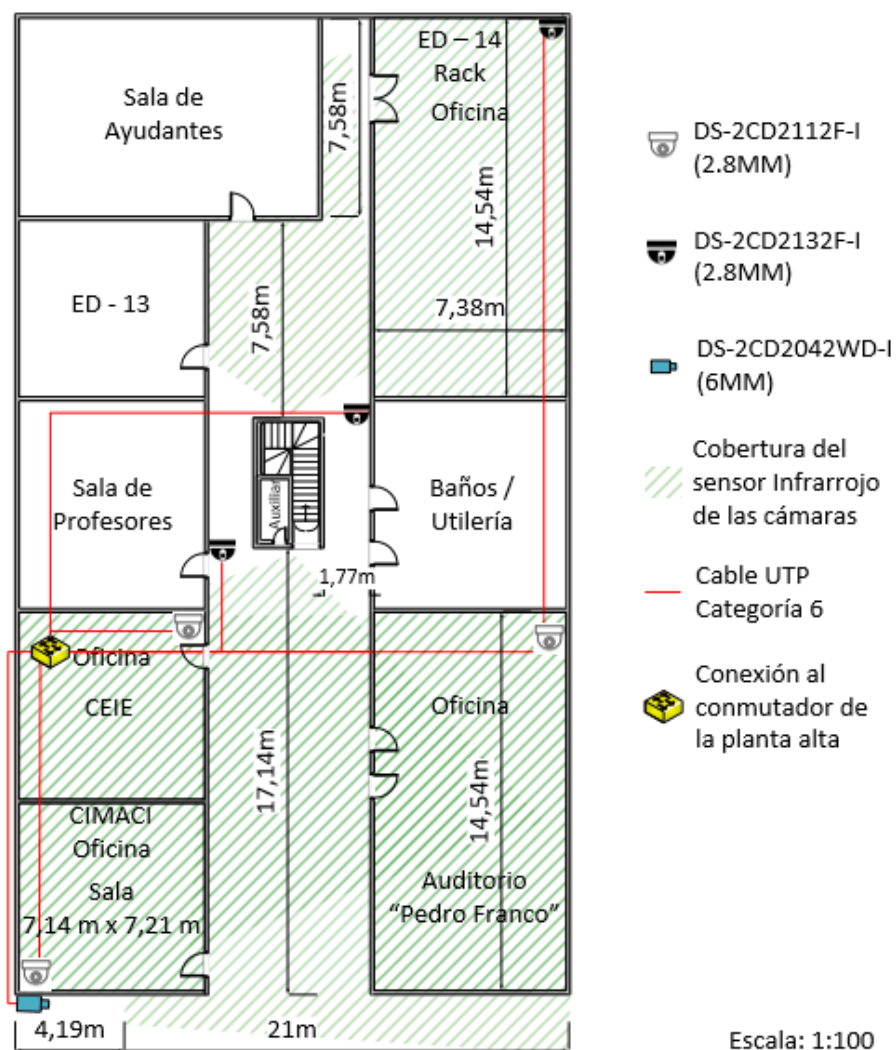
Ubicación de las cámaras el edificio 32 D, planta baja.
